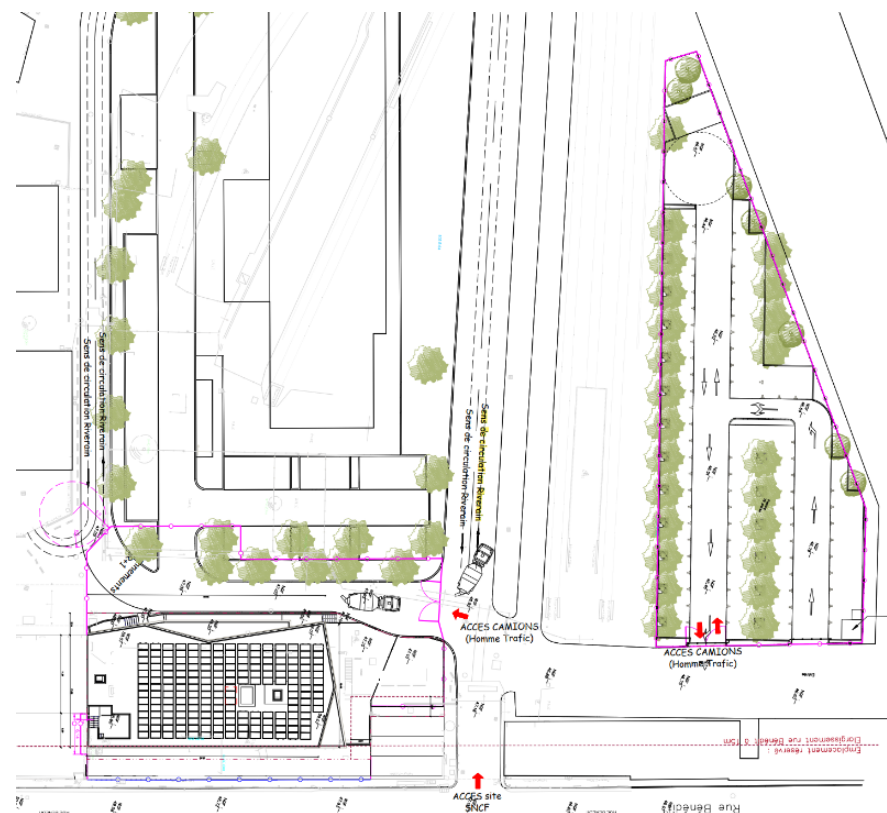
Zone d'installation de chantier au niveau de Cour des Pierres
